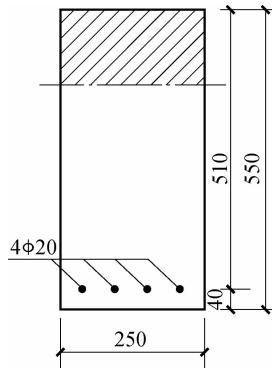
【例 3-1】截面配筋(尺寸单位:mm)
